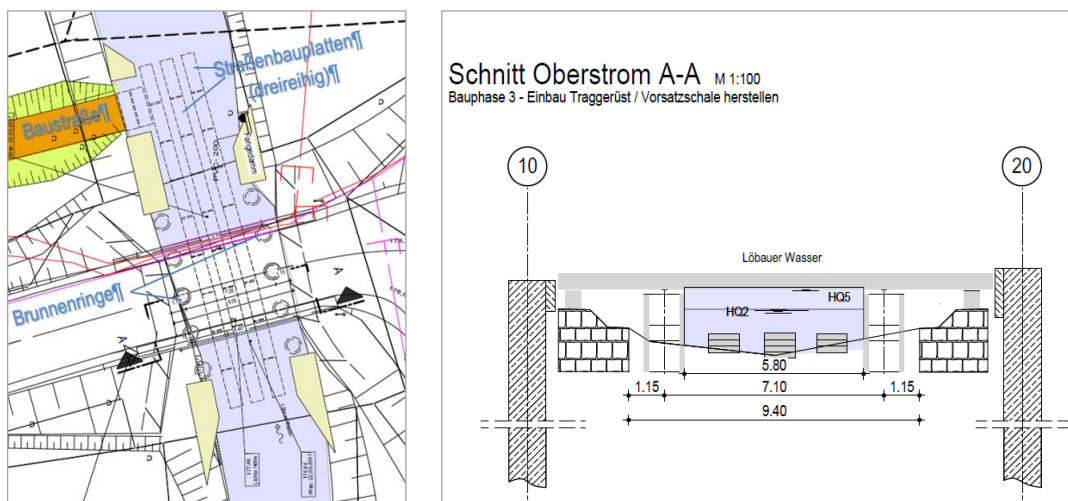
Lage der ursprünglich geplanten Baustraße im Löbauer Wasser sowie der mit dieser Lösung erforderlichen Brunnenringe. Rechts: Einbau Traggerüst zur Herstellung der Vorschale (INGENIEURBÜRO SCHULZE & RANK 2020; Bauphasenplan – Arbeitsstand vom 27.02.2020)
